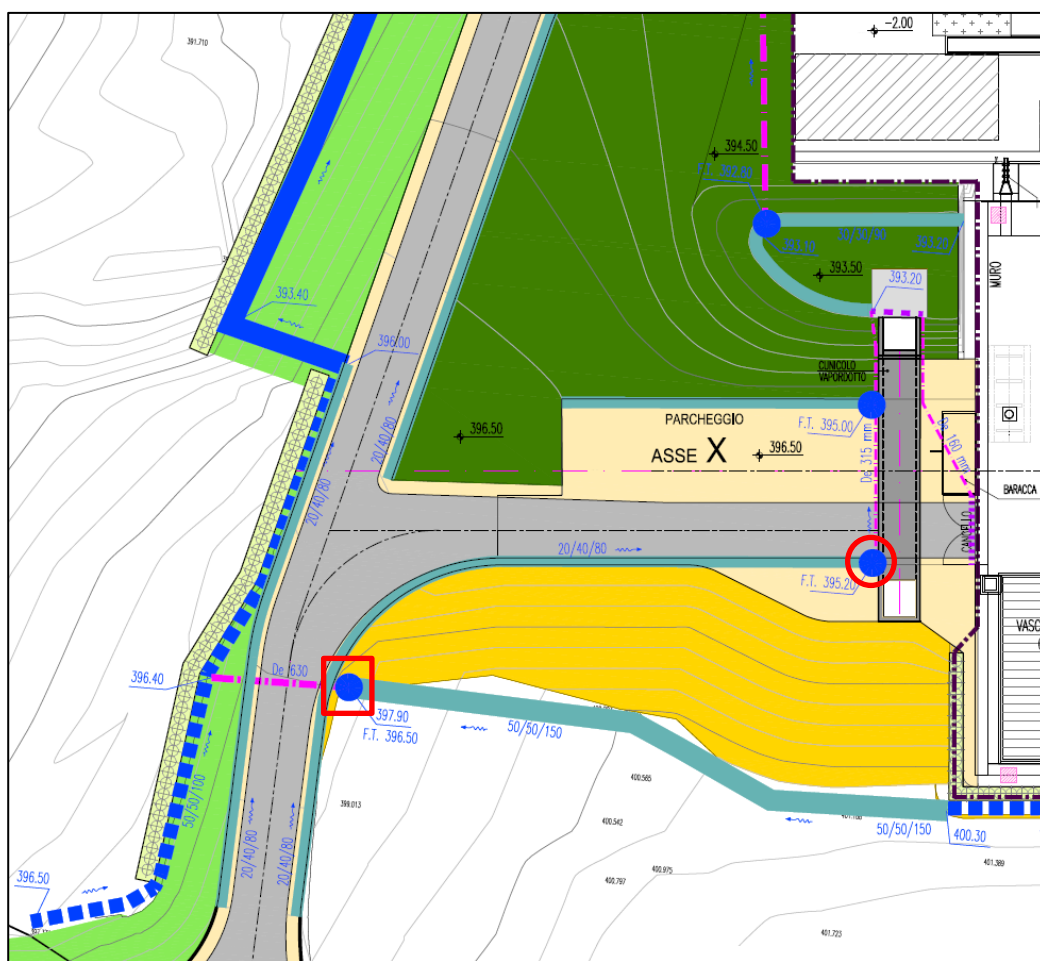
Planimetria di progetto della rete idraulica di intercettazione ed allontanamento delle acque esterne alla postazione (stralcio inizio strada di ingresso).
